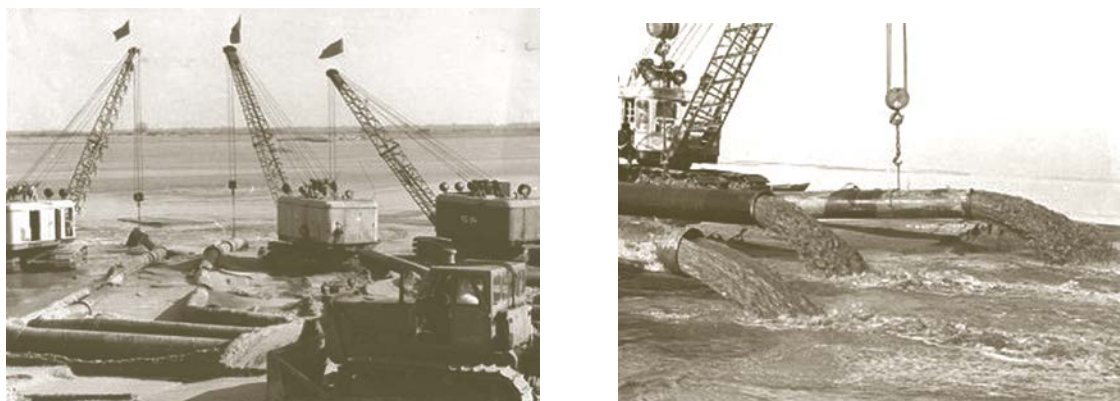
Перекрытие русла реки безбанкетным способом
